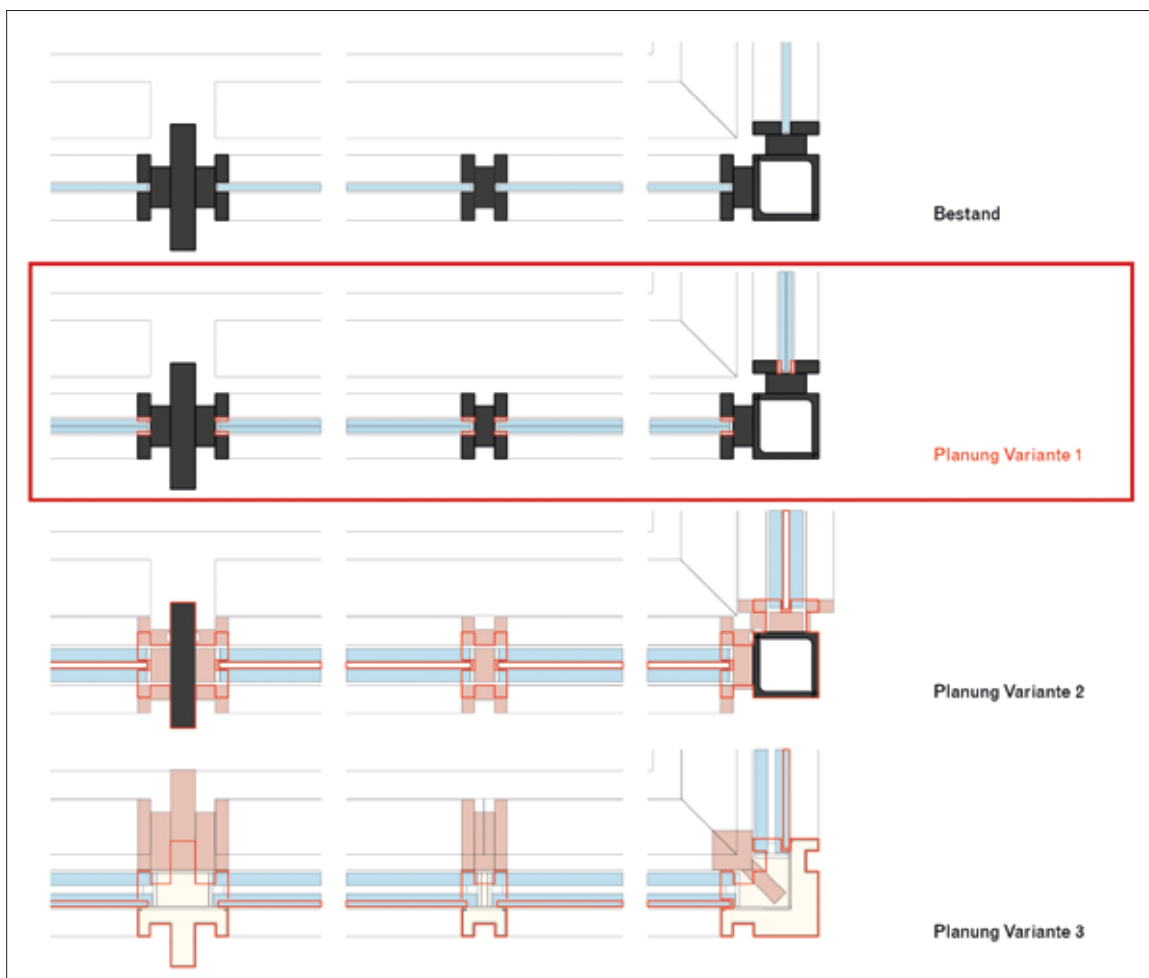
Stahl-Glas-Fassade der oberen Halle
